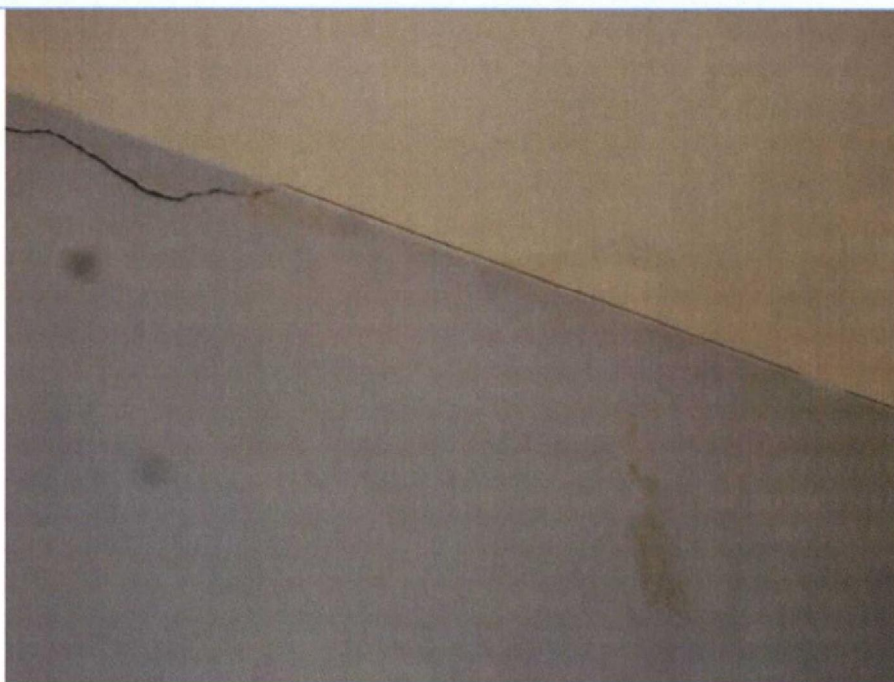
Scheuren in het plafond bij de aansluitingen van de plafondplaten onderling. Geen verband met bodemtrillingen.
